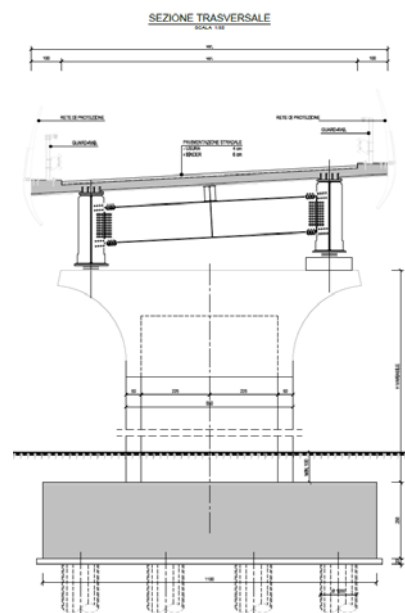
Viadotto Svincolo Bradano: sezione impalcato/pile
